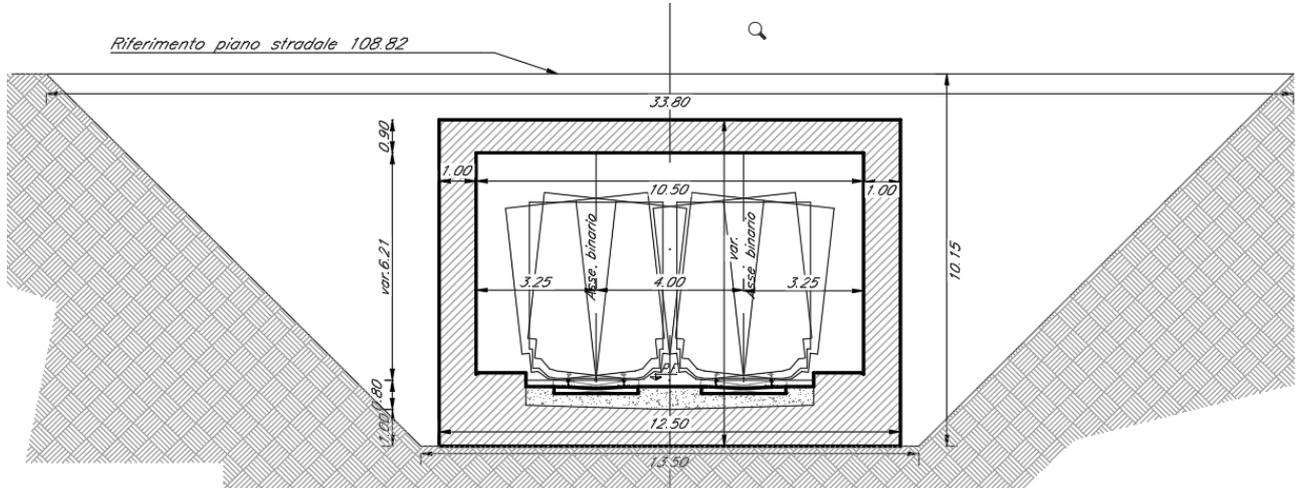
Sezione trasversale galleria artificiale spinta a vuoto con preventivo scavo e riempimento in cover-beton
